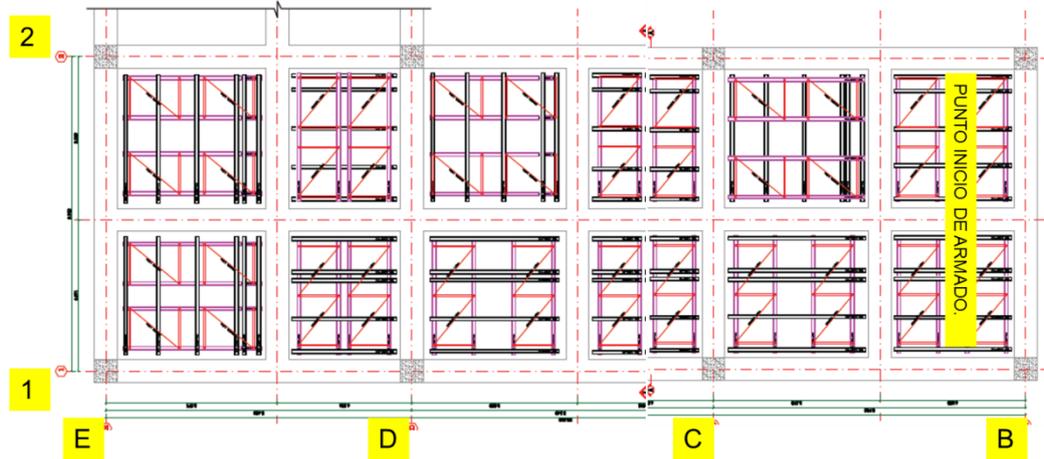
Vista en planta de la distribución de los andamios de carga en vigas
